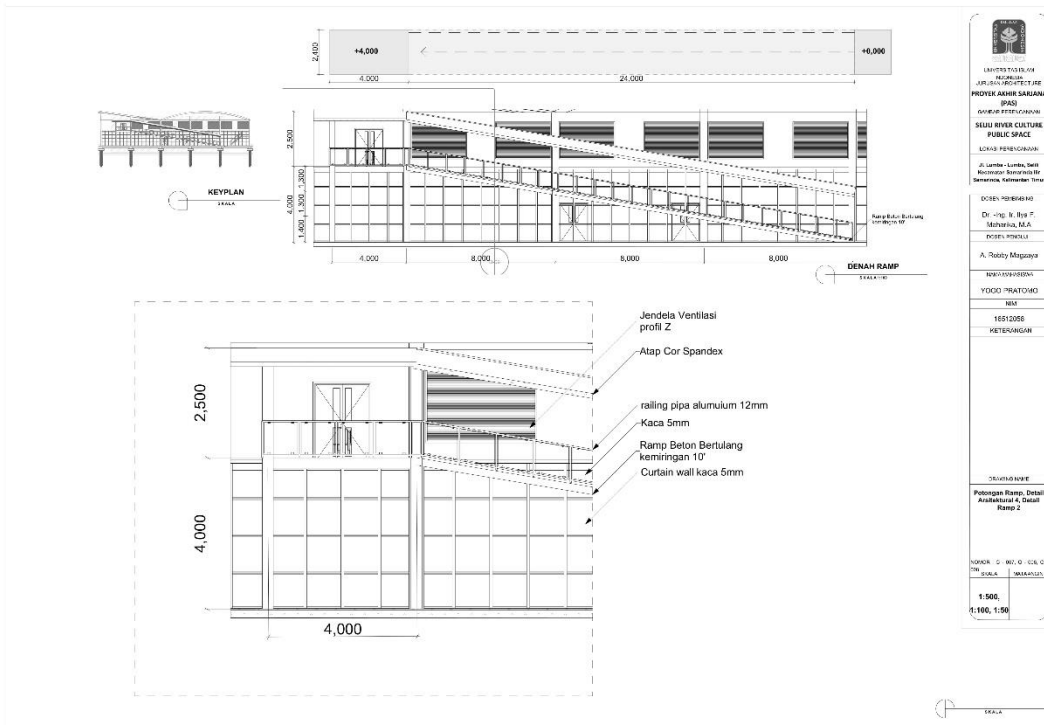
Detail Buka-an Ventilasi)
